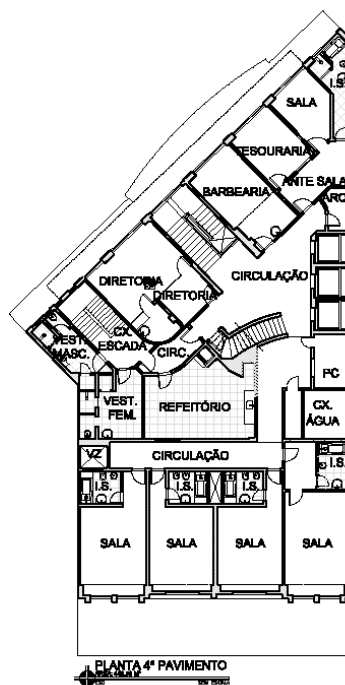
PLANTA 4º PAVIMENTO – HOTEL NORMANDY – ELABORADO PELA AUTORA – 09/2011.
